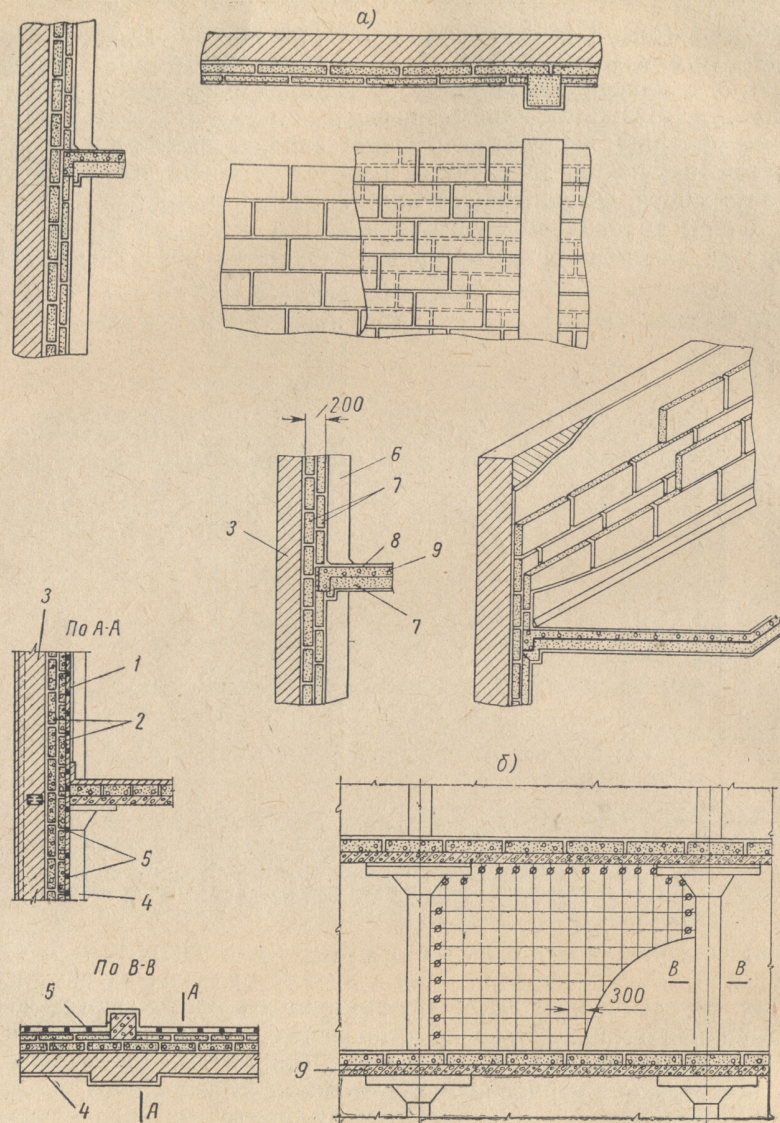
Конструкция теплоизоляции пенобетонными блоками стен холодильника:
